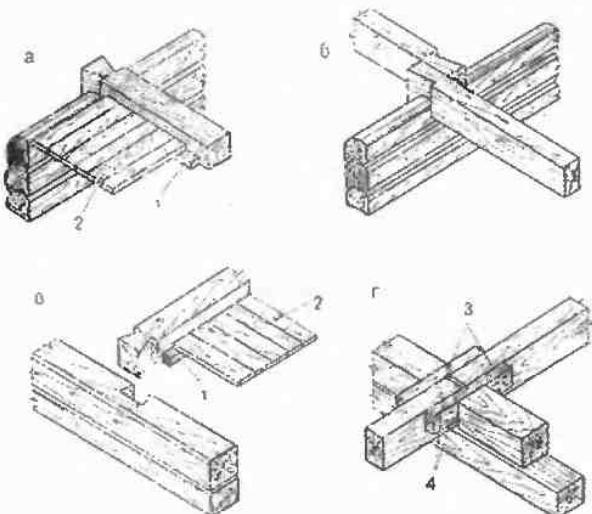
Сопряжение балок перекрытия с деревянными стенами
